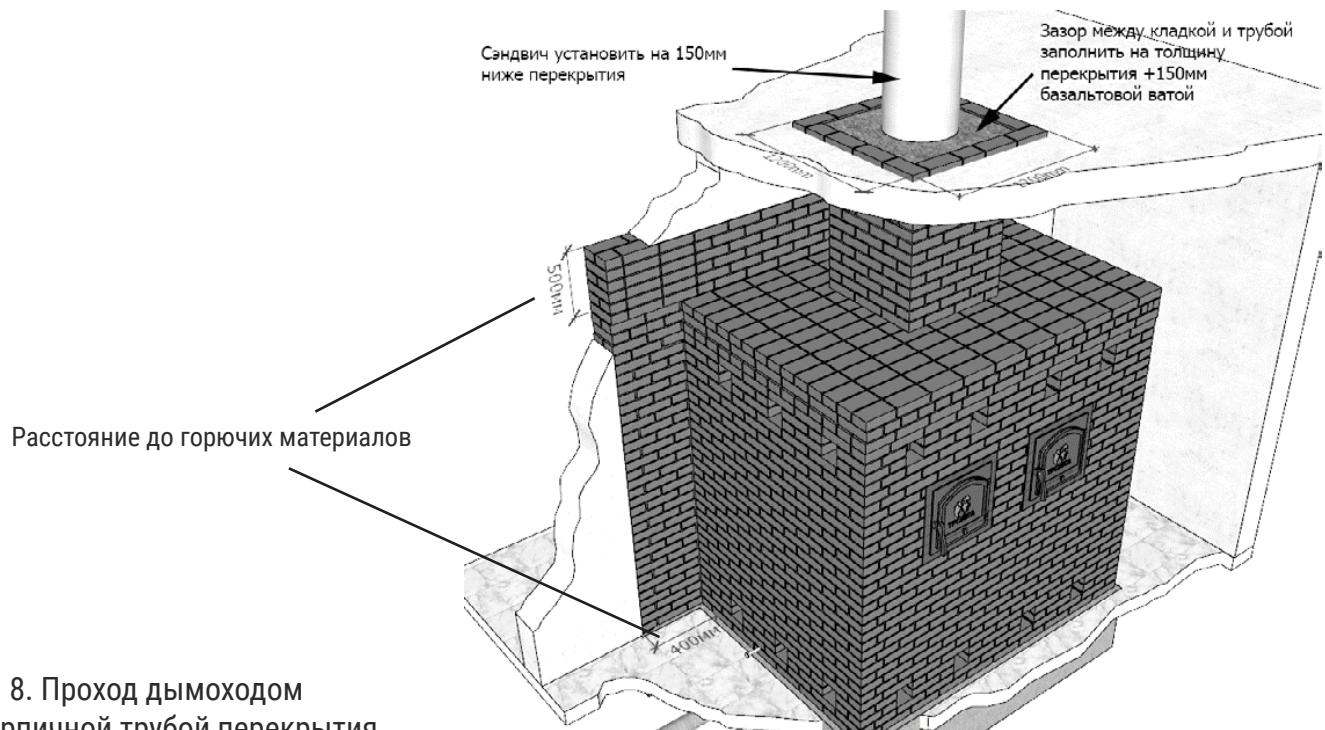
Проход дымоходом и кирпичной трубой перекрытия.
